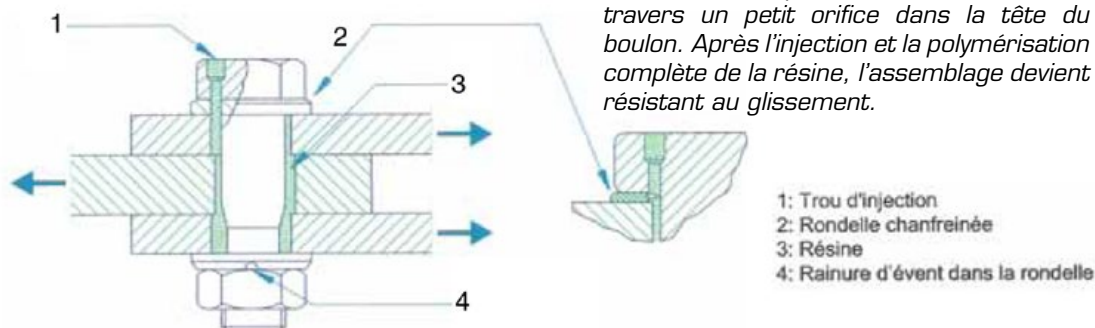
Boulon injecté dans un assemblage à double recouvrement (NF EN 1090-2 annexe K).
